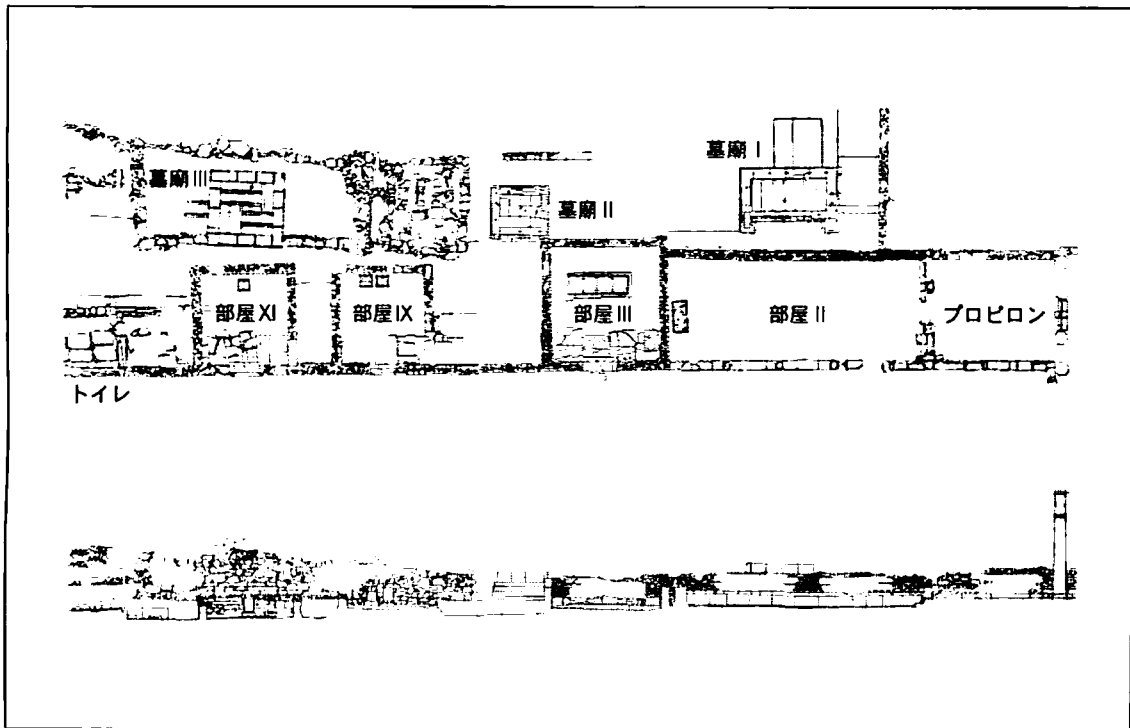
スタディオオン地区の墓地の敷地図 (上: 平面図、下: 立断面図)
